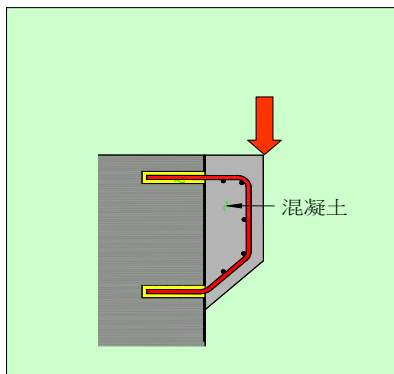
混凝土擴座作用力及承載寬度檢核示意圖
